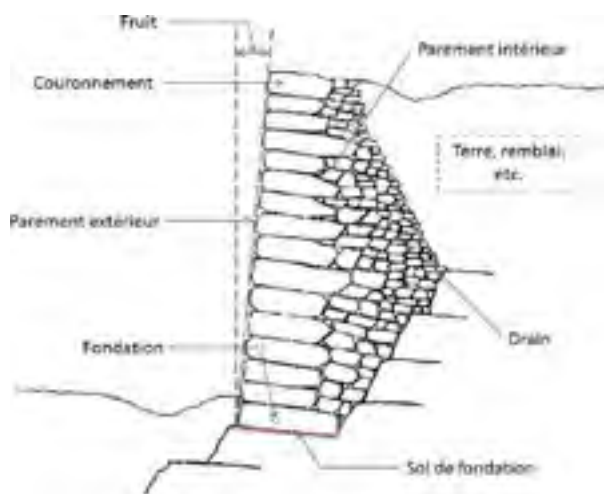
Différentes parties d'un mur de soutènement en pierres (Adapté de Alava et al., 2009)
